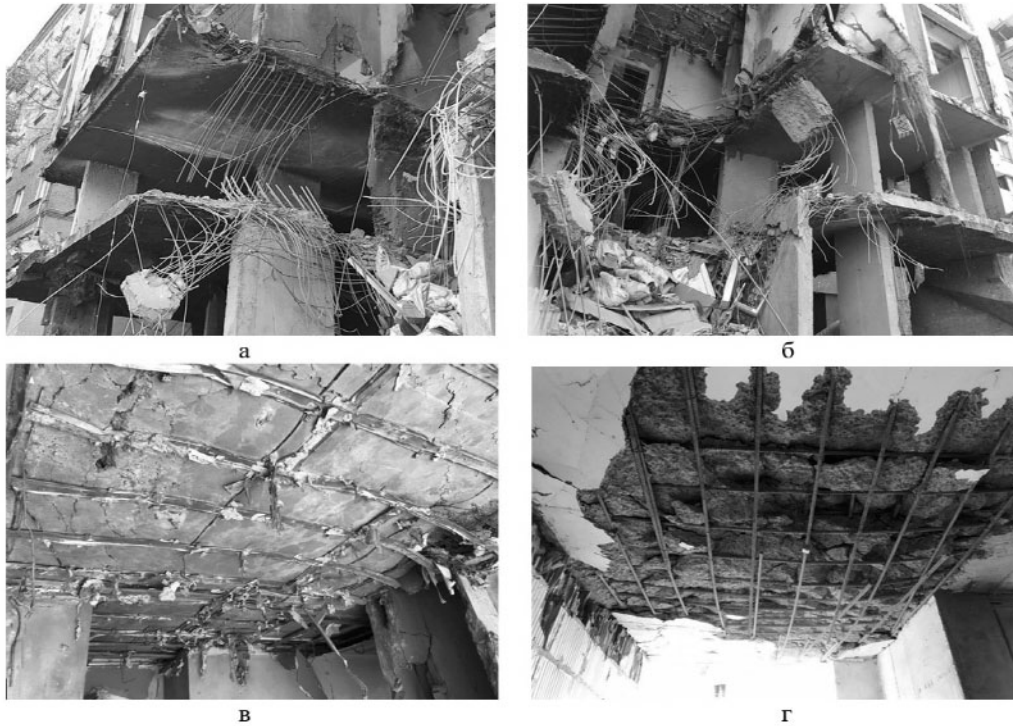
Руйнування несучих конструкцій житлового будинку внаслідок ракетного удару: а, б - повне руйнування пілонів, та частини перекриття будинку; в, г – вигин та прогин плити перекриття внаслідок ударної хвилі
